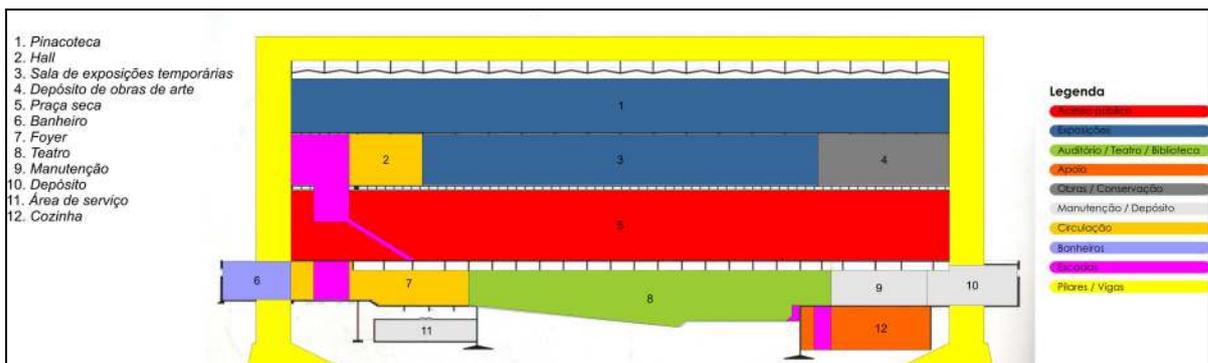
Corte longitudinal (adaptada de BARDI, 1992).
